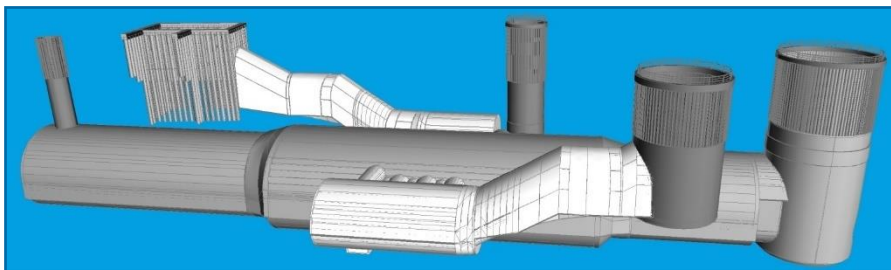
Vista tridimensional das escavações com destaque para a configuração do acesso Sul
